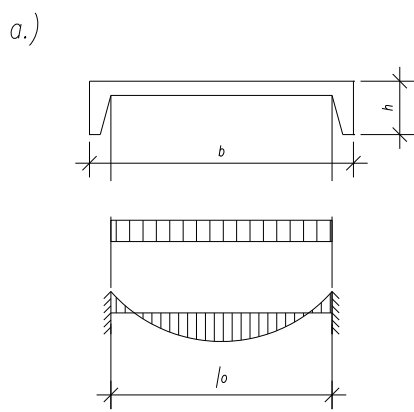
К расчету верхней полки на местный изгиб в ребристых плитах и пустотных с овальными пустотами
